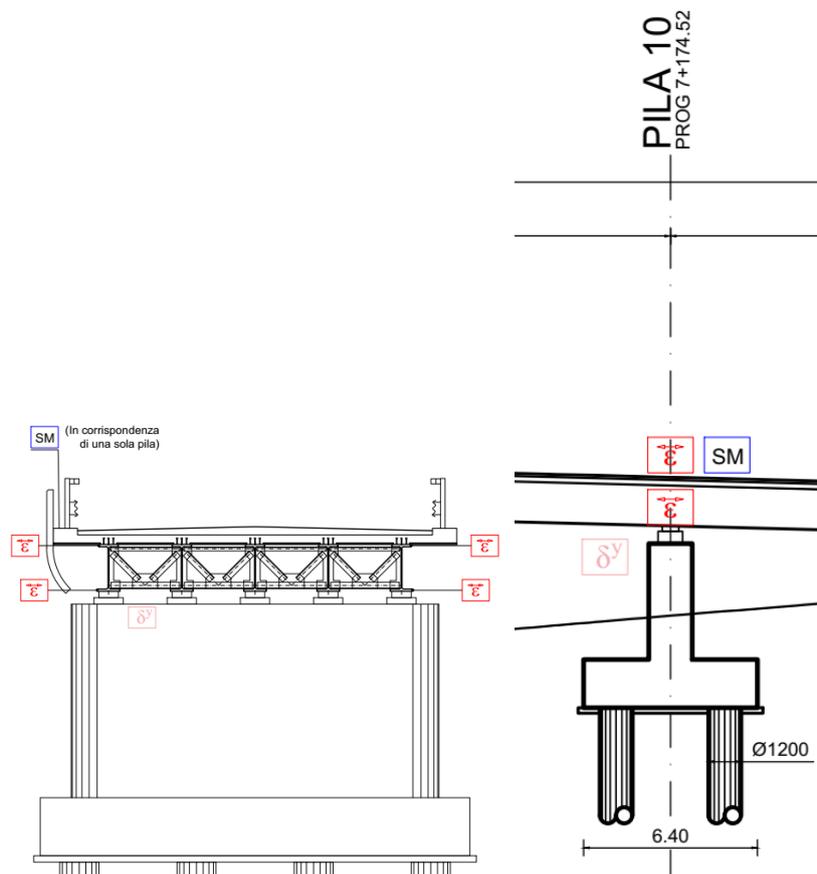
Ubicazione sensori su pile (sezioni e fondazione viadotto Collestrada)
